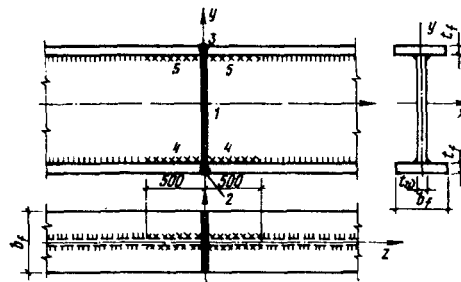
Порядок сварки укрупнительного стыка двутавровой балки
